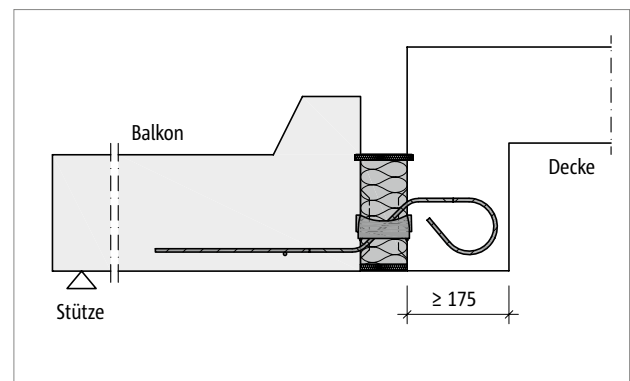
Schöck Isokorb® T Typ QL: Einbausituation «Balkonplatte als Element»
